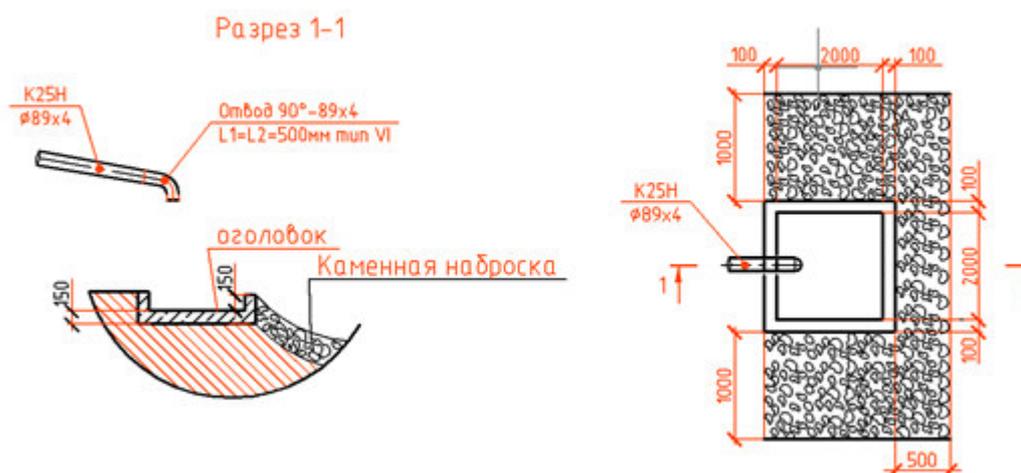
Оголовок выпуска (план, разрез)
